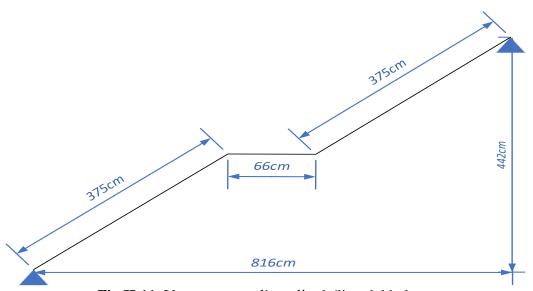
Vue en coupe d'escalier hélicoïdal balance
